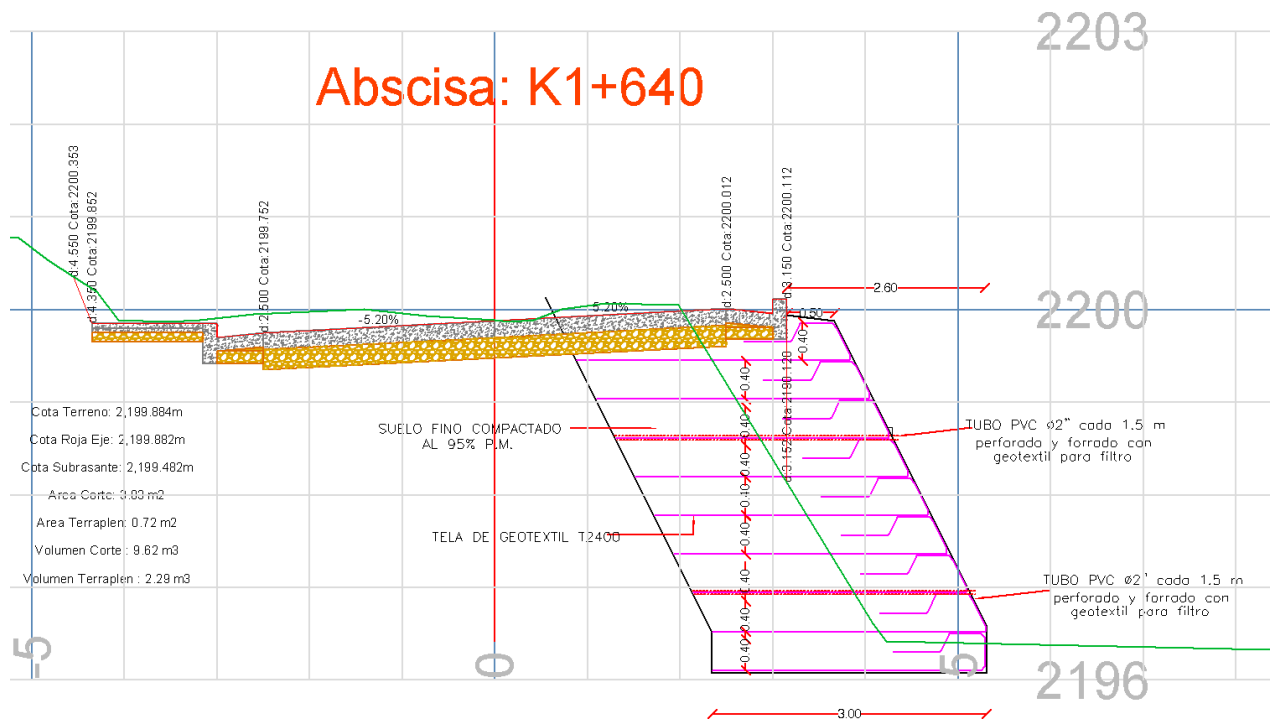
Terraplén con talud reforzado con geotextil (K1+643)
